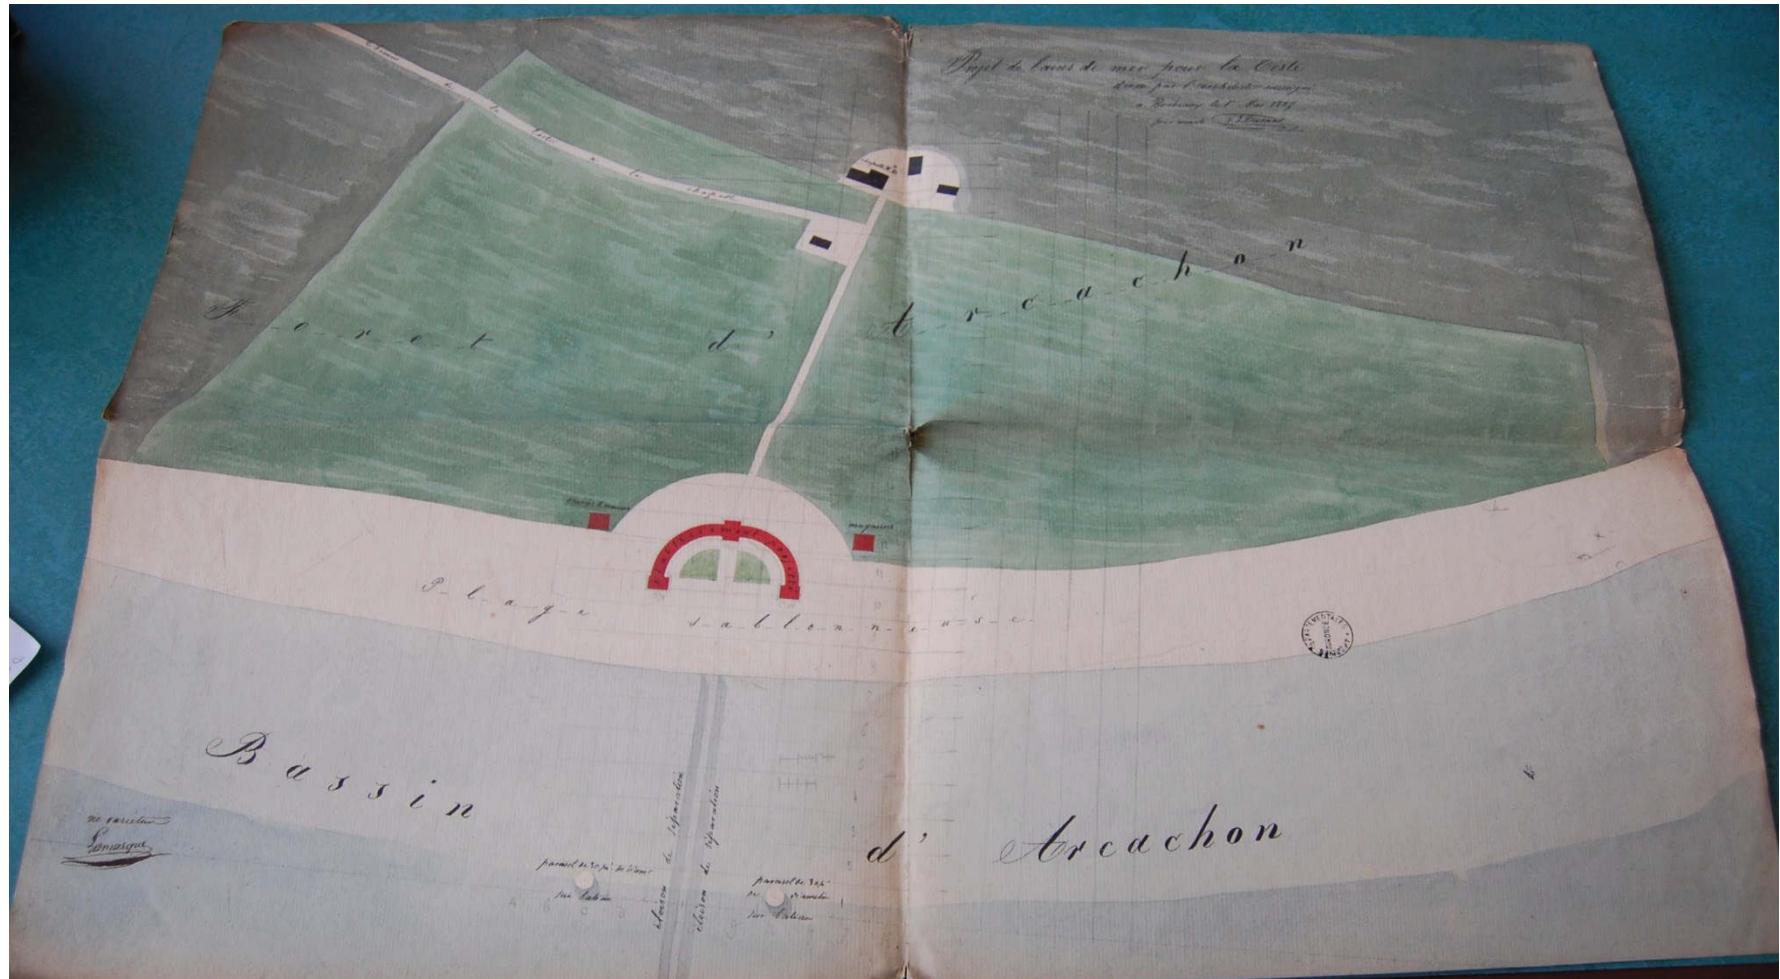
Gabriel-Joseph Durand. *Projet de bains de mer pour la Teste*, dressé par l'architecte soussigné, à Bordeaux le 1er mai 1827, pour minute, plan signé, ADG 5 J 72
